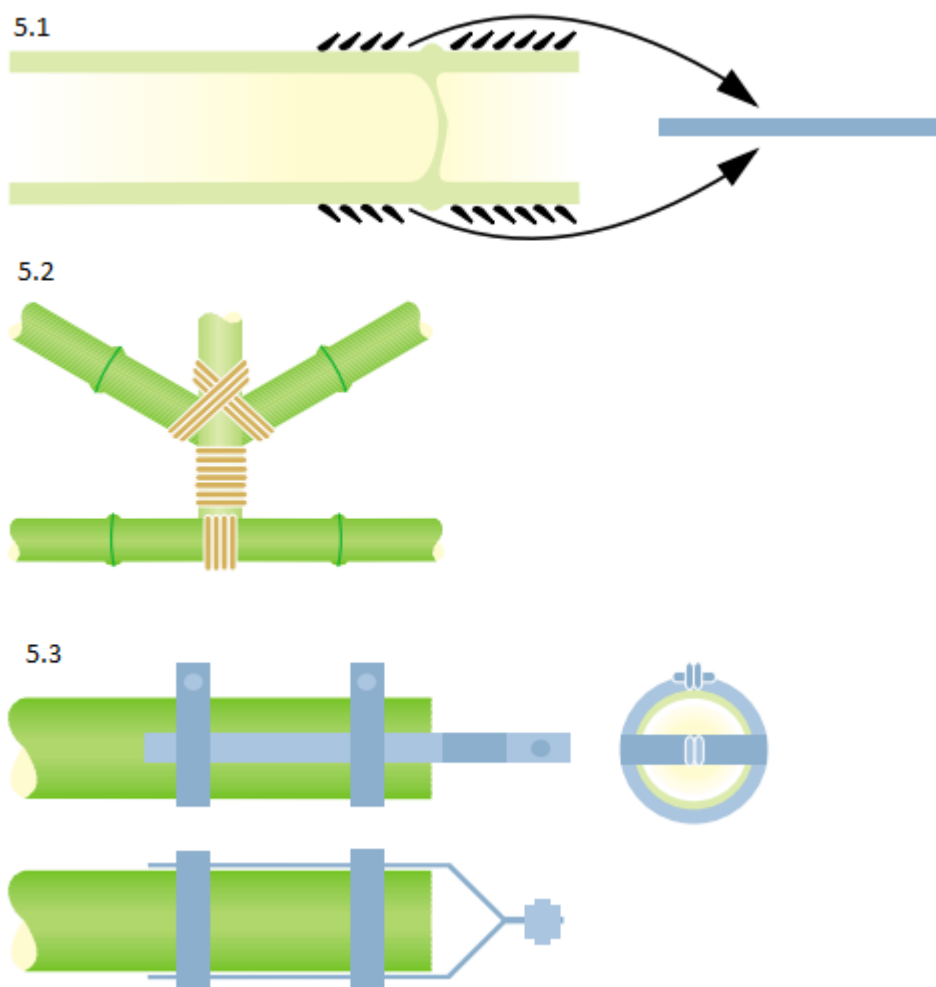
Subtipos de conexiones tipo 5. Fuente: Jansen
